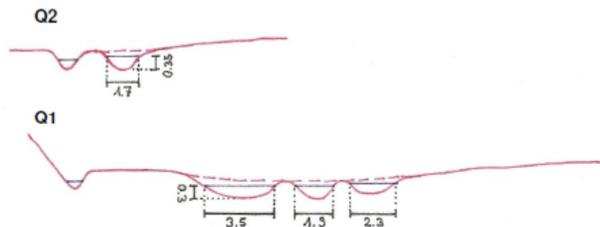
Plan Massnahme 2, (Planzeichnung: THOMAS HERTACH)
